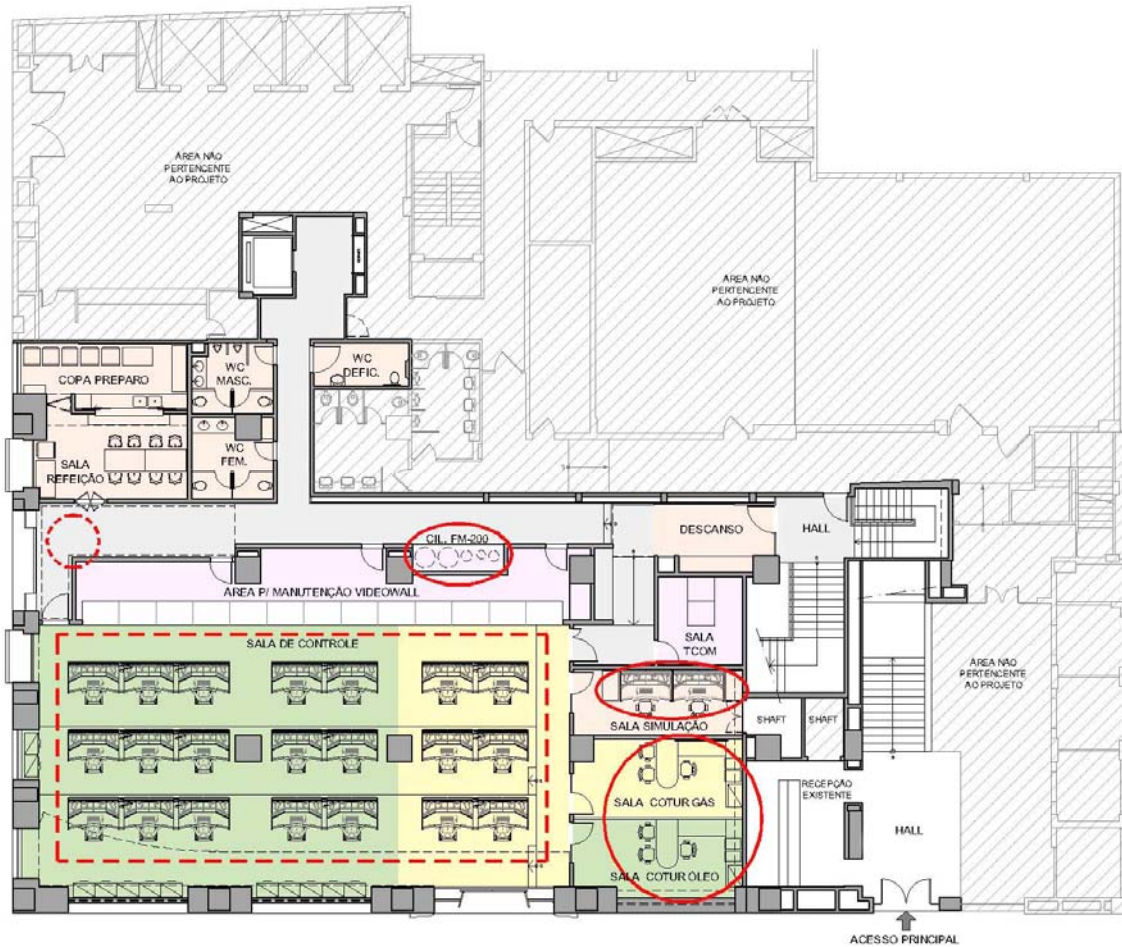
Planta baixa pavimento térreo: layout apresentado na entrega do *milestone 5
